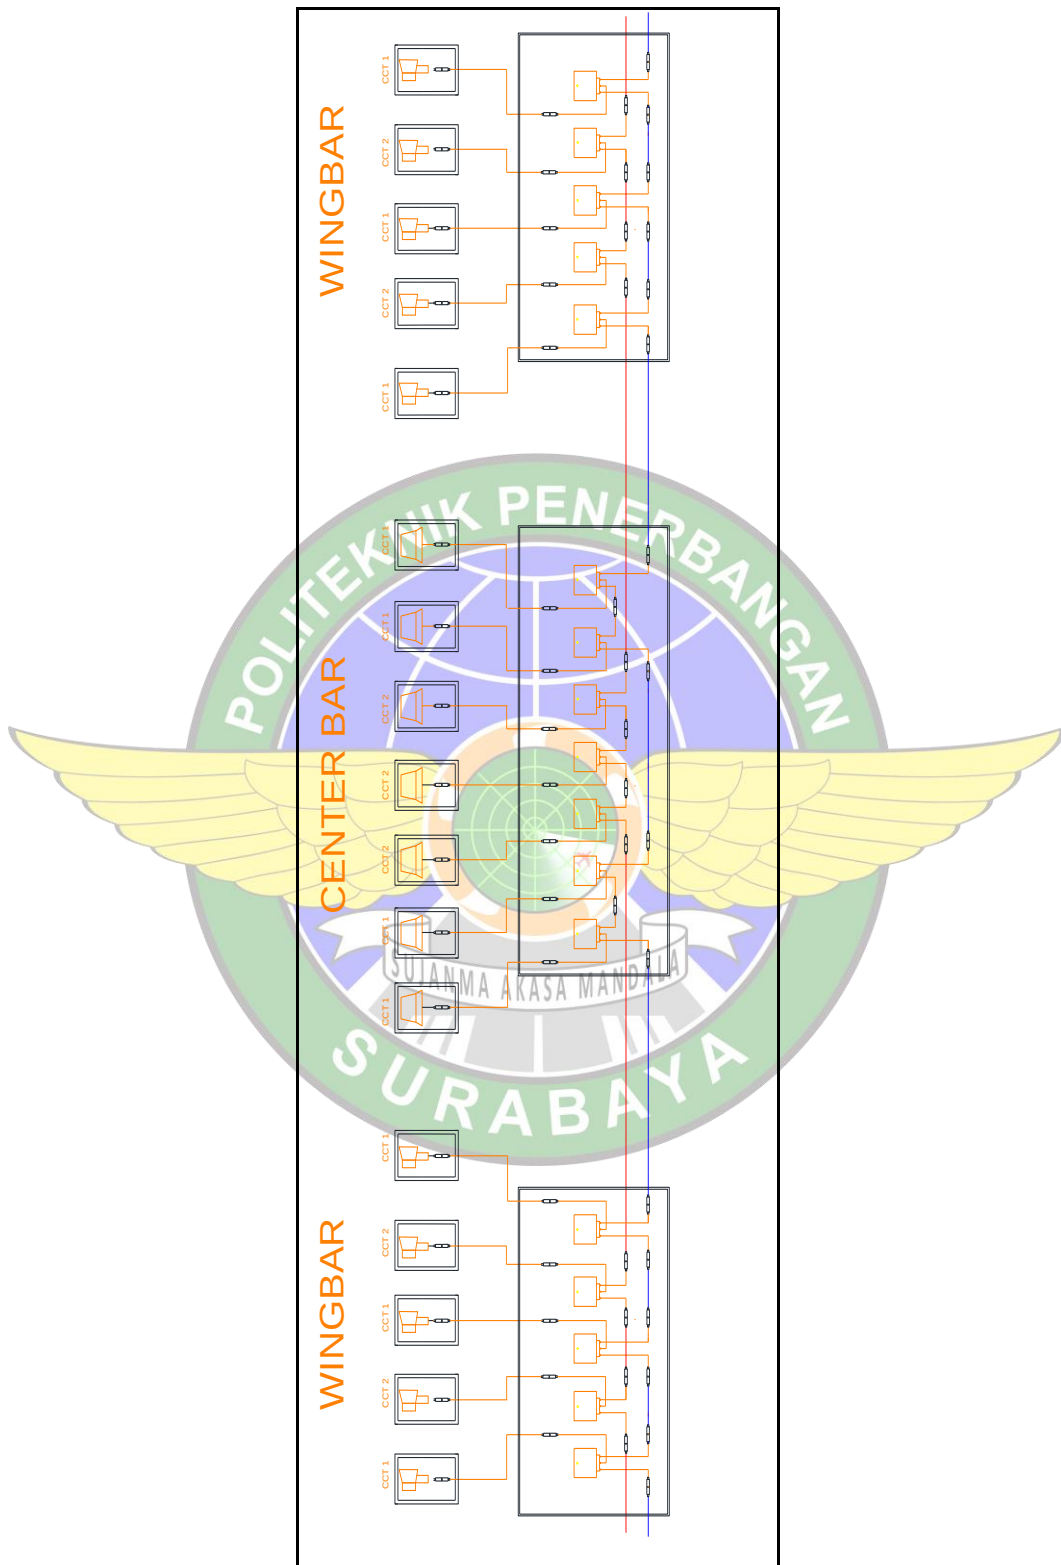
8 Desain detail instalasi kabel *runway edge light* di runway 27
